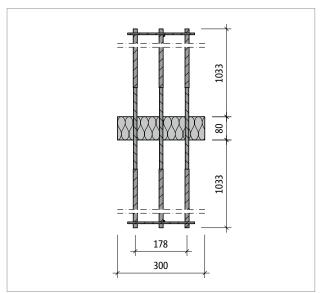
Schöck Sconnex® type W-T1-LW : coupe A-A du produit
